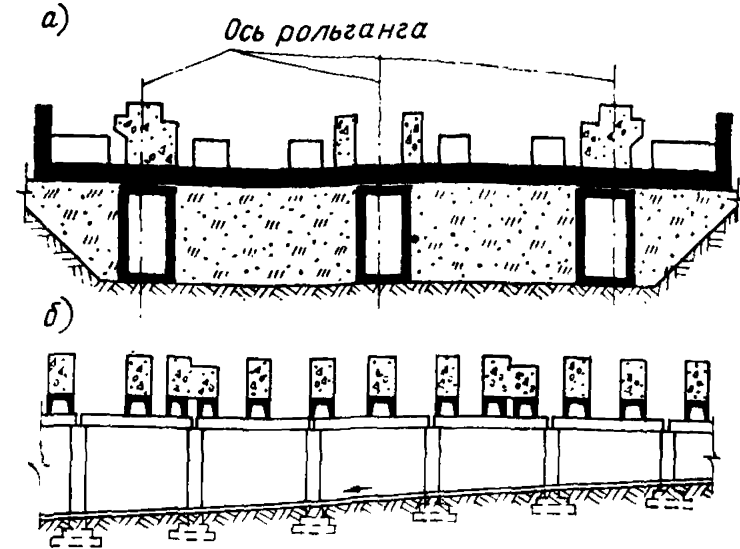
Фундаменты под вспомогательное оборудование (холодильники) в сборно-монолитных конструкциях
